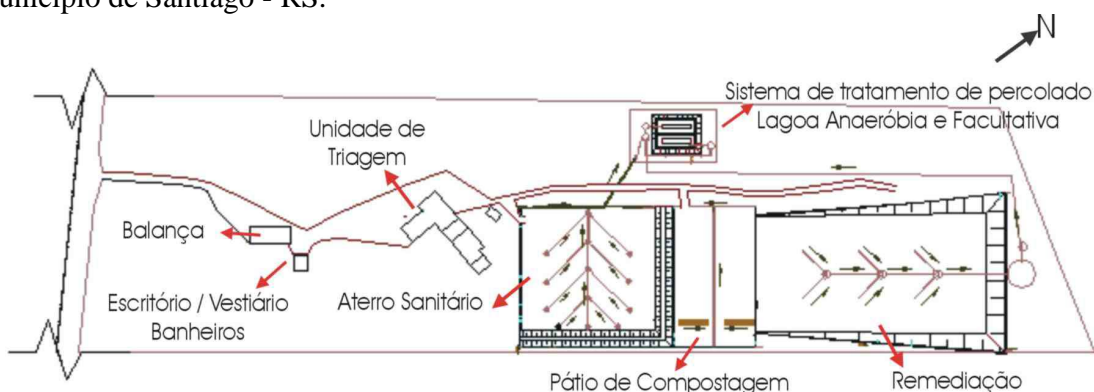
Esquema da planta baixa do final das obras projetadas para a UTCAR – Santiago – RS.
